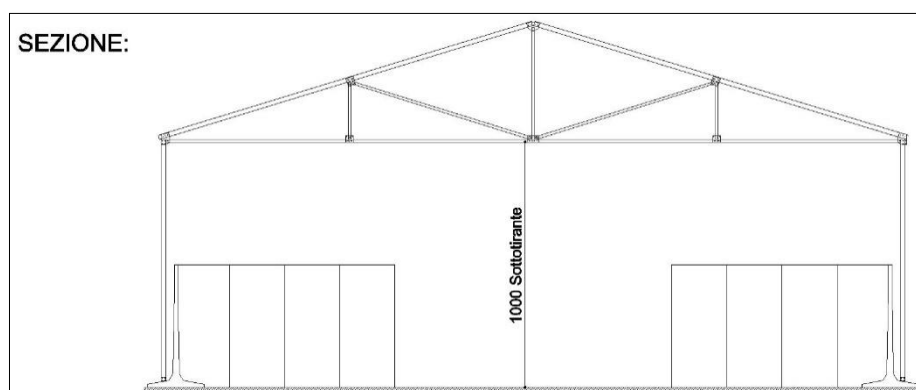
/B – Prospetto del fabbricato in progetto (non in scala).
